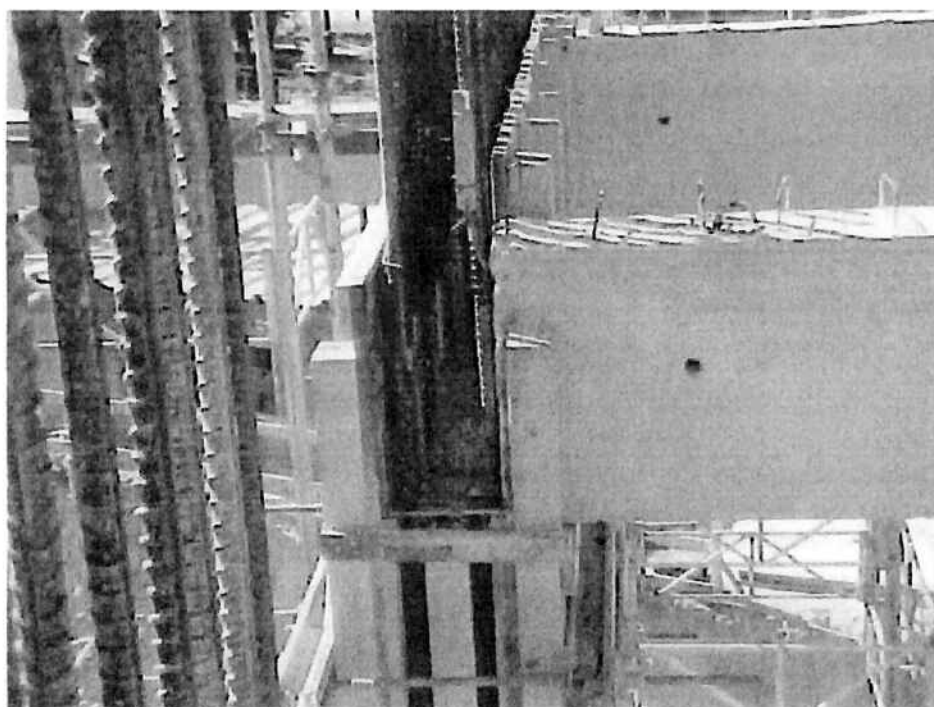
Pré-viga apoiada na fôrma da coluna
